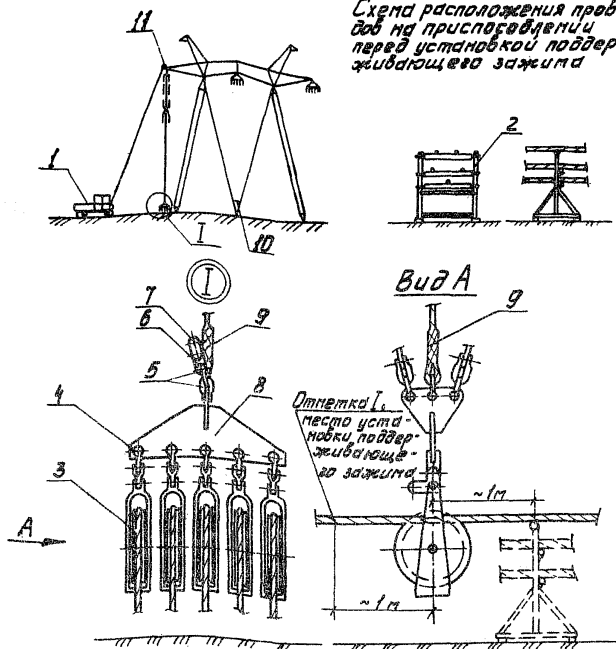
Перекладка проводов крайней фазы с опусканием на землю.
